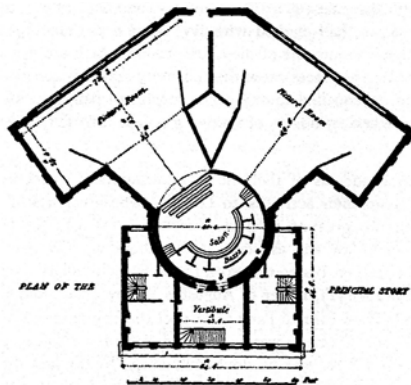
Planta Baixa da Pinacoteca do Instituto de Artes/UFRGS
